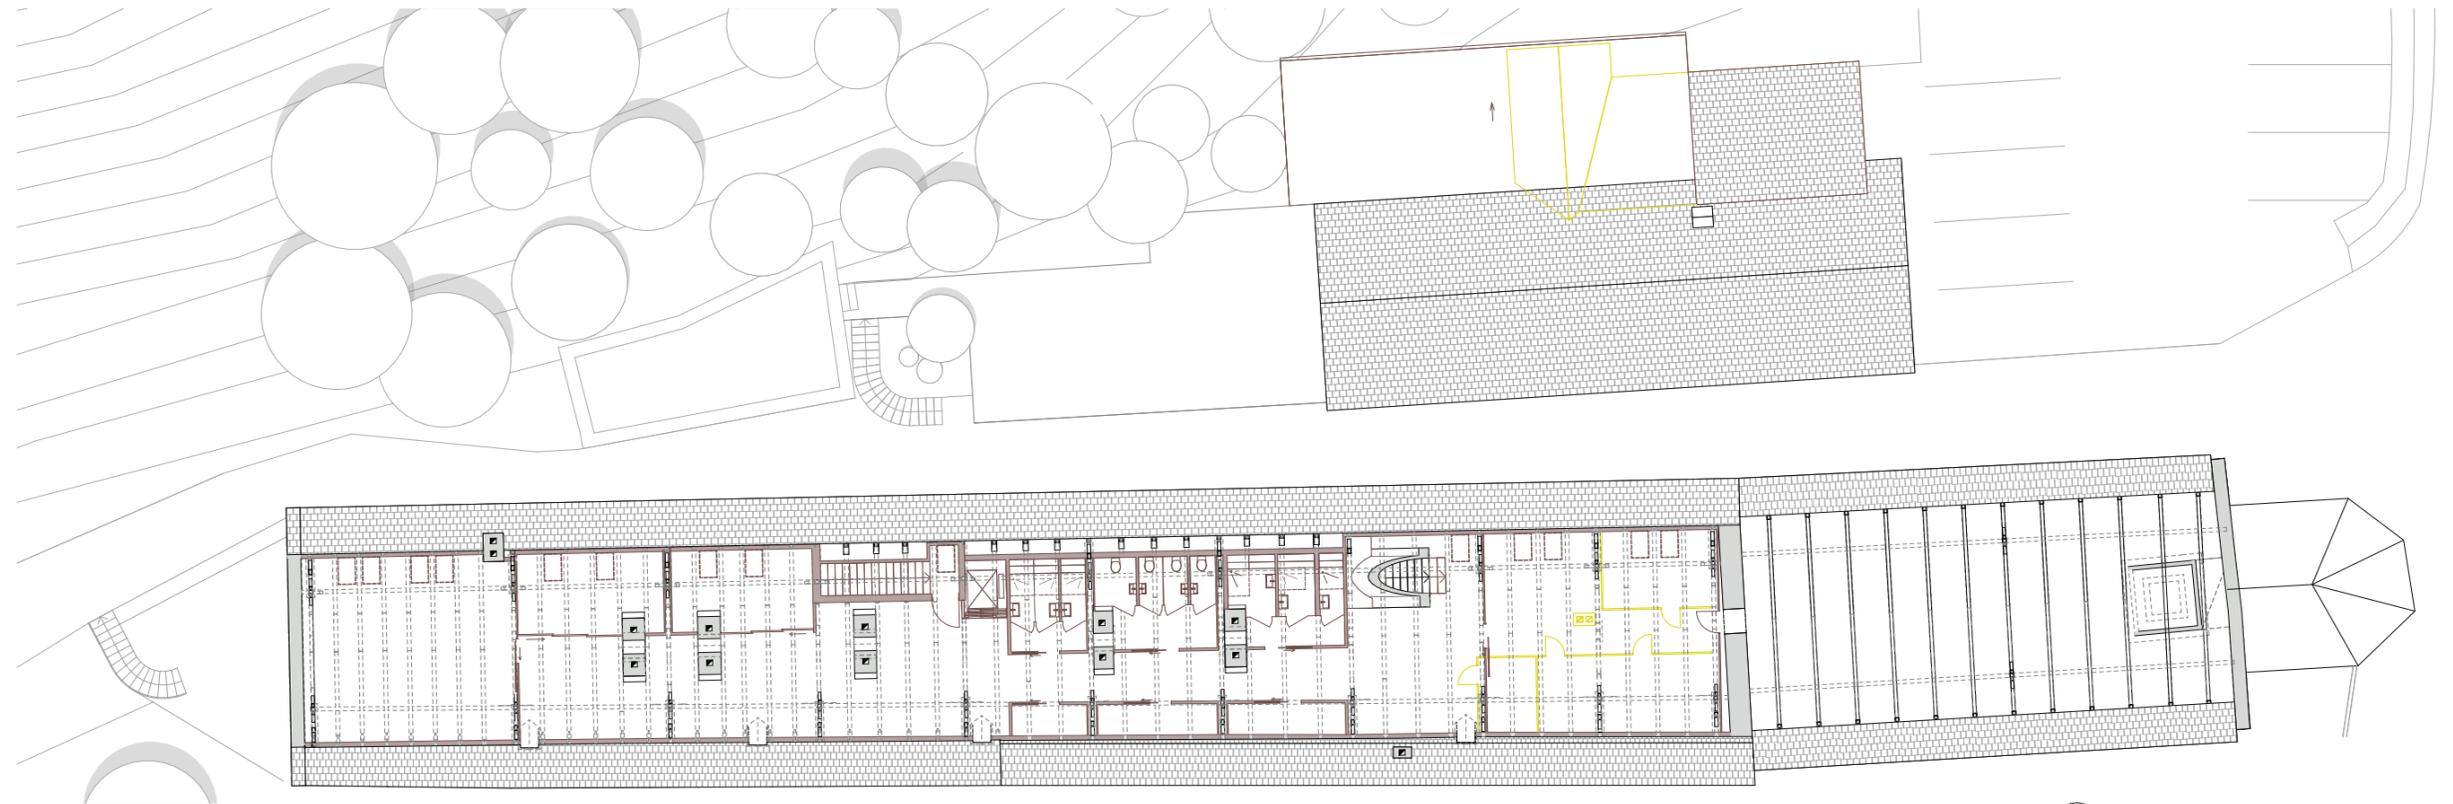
Bauliche Eingriffe. Dachgeschoss Spitalstrak und Spitalkirche, Dachdraufsicht Wirtschaftstrak
